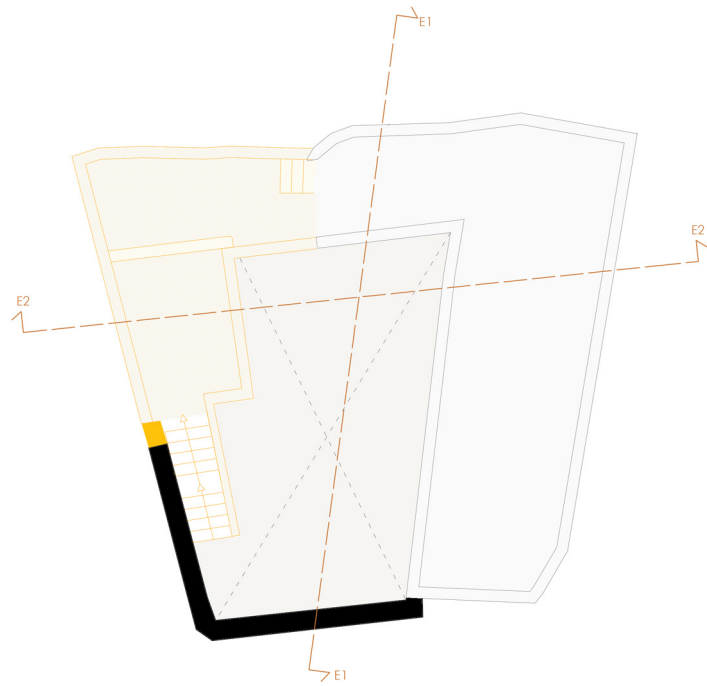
Interventi di distruzione al primo piano | Scala 1/200
